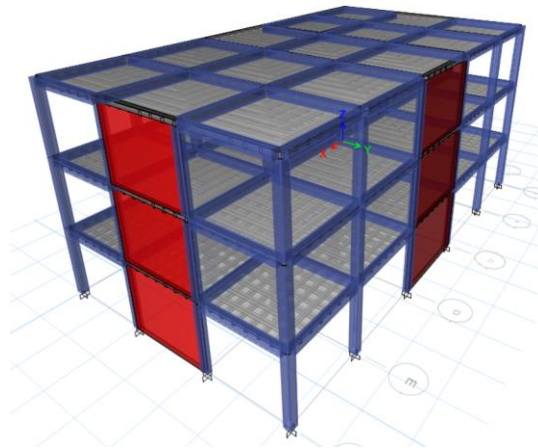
Representación de la estructura de muros de corte 3P.
